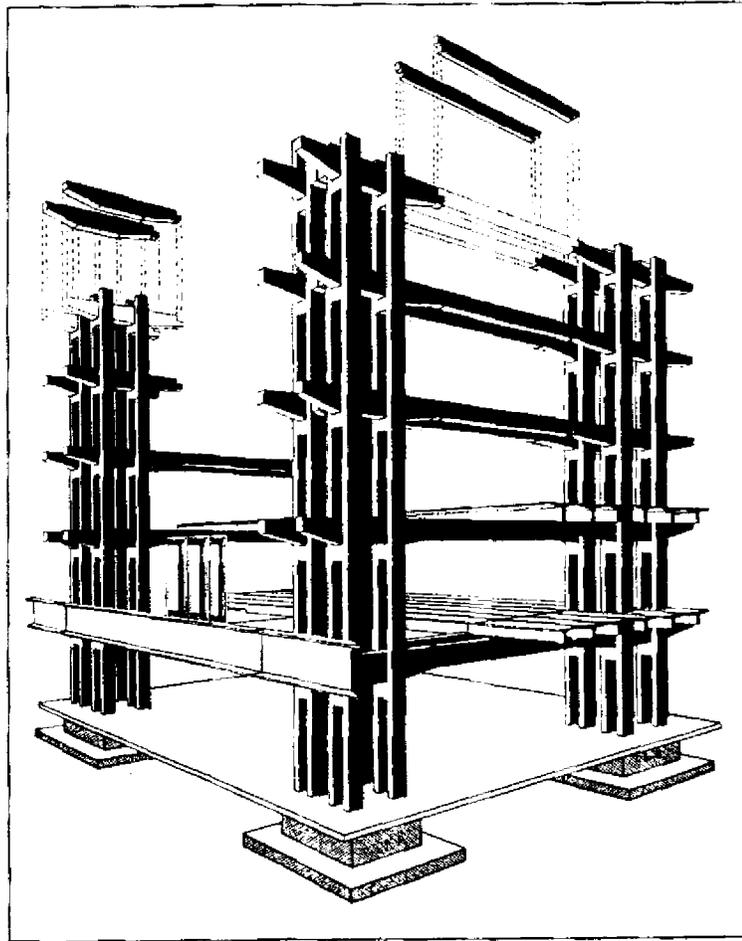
Perspectiva del sistema estructural (Rioboo, 1990)
